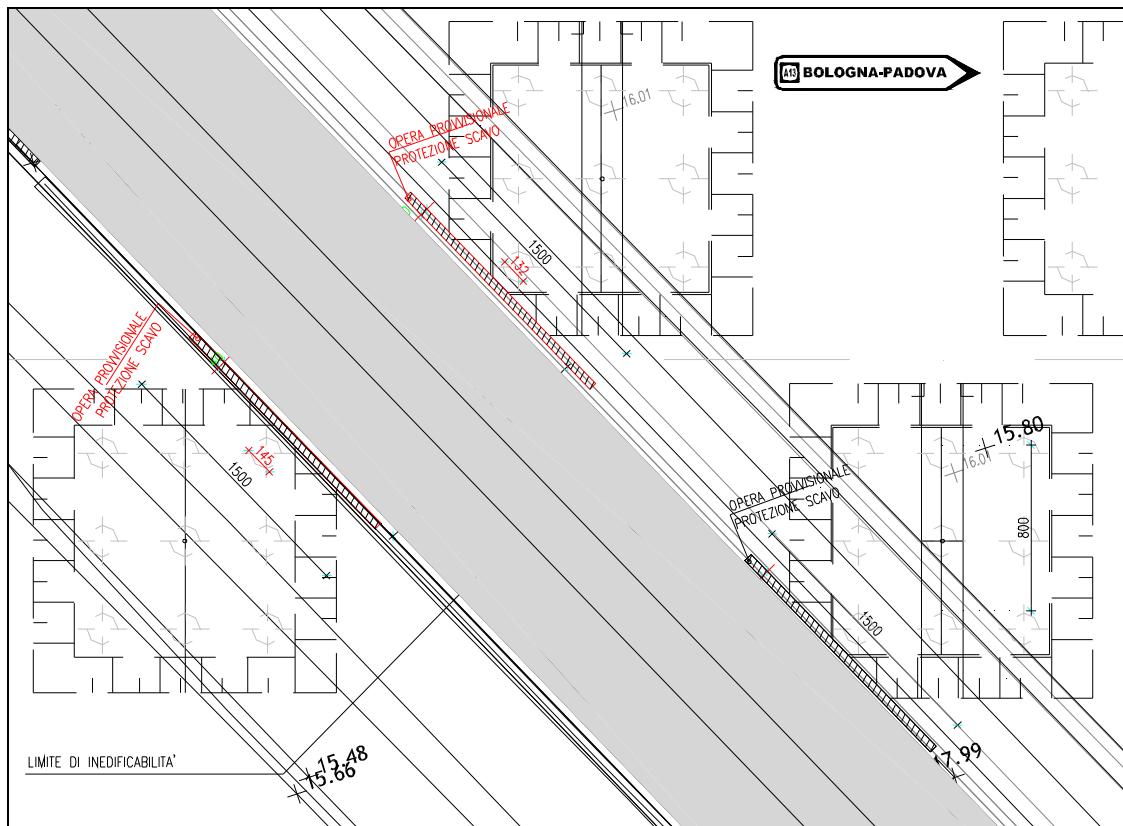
AVI01 – PLANIMETRIA OPERE PROVVISORIALI.
